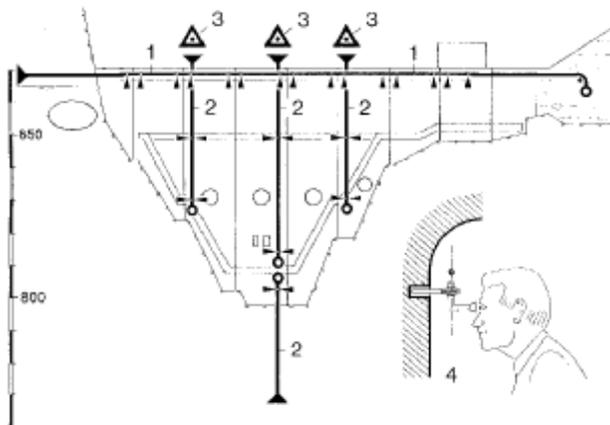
Exemple d'une disposition moderne de stations de mesure d'alignement
